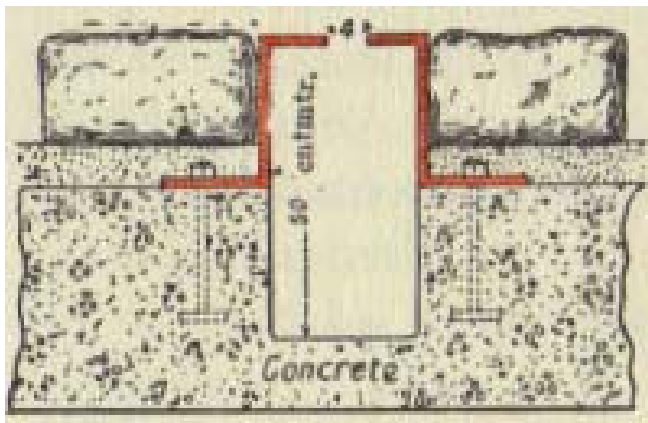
“Calçada da Lavra (...) a section of the slotted cable tube”.
